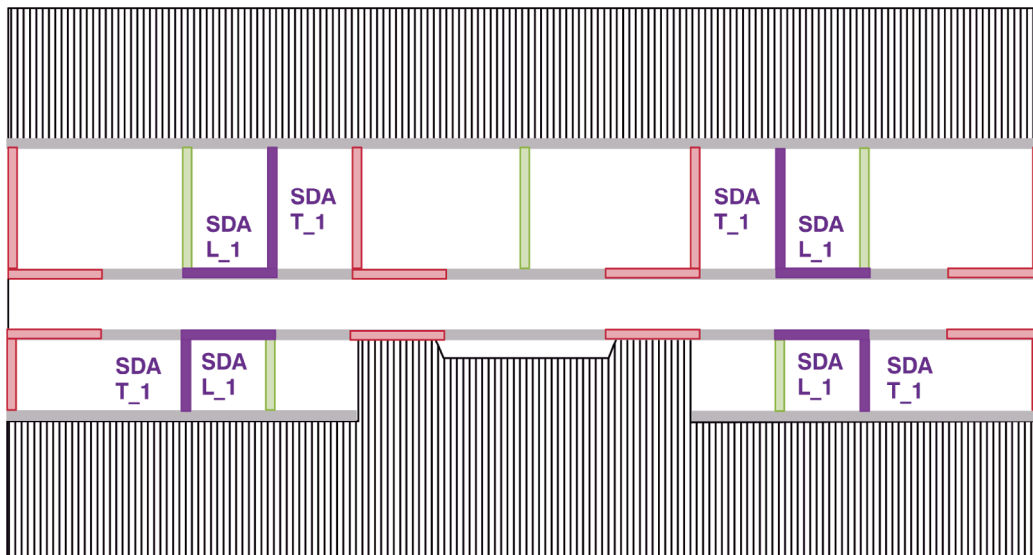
Schema di disposizione in pianta dei sistemi dissipativi aggiuntivi.
